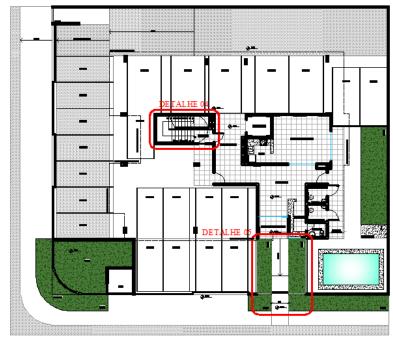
Planta Baixa - Pavimento térreo (2)
